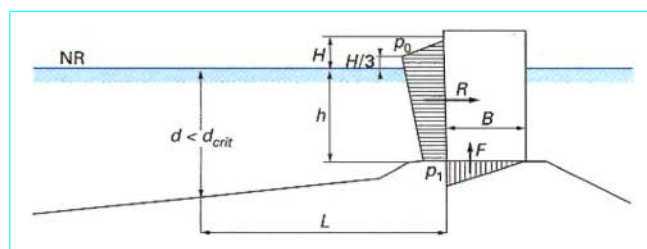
Surpressions dues à la houle sur une digue mixte en faible profondeur
